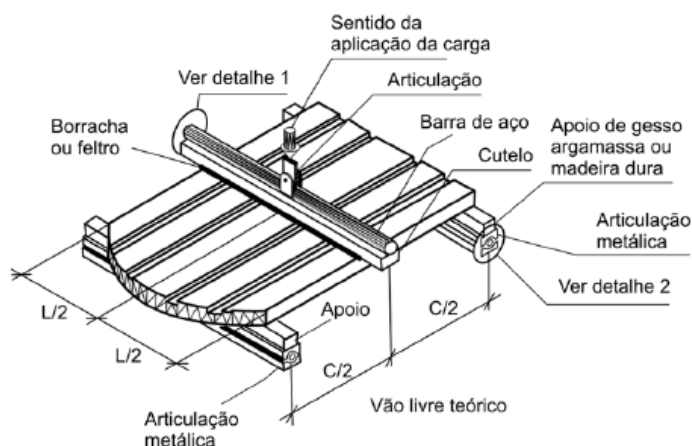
Dispositivo para aplicação de carga. (Fonte: NBR 15310 (ABNT, 2005).
